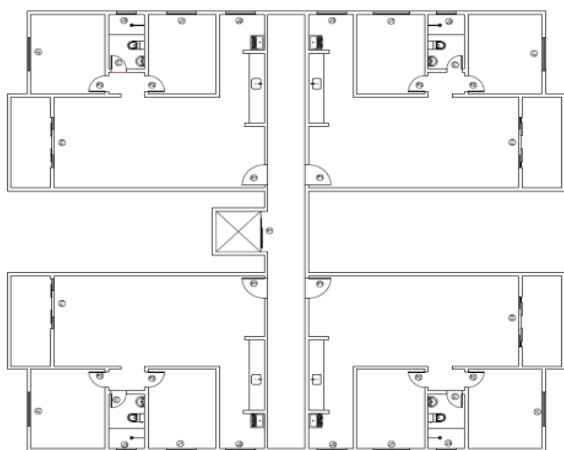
Planta arquitetônica do pavimento tipo. Fonte: Próprio autor, 2015.
